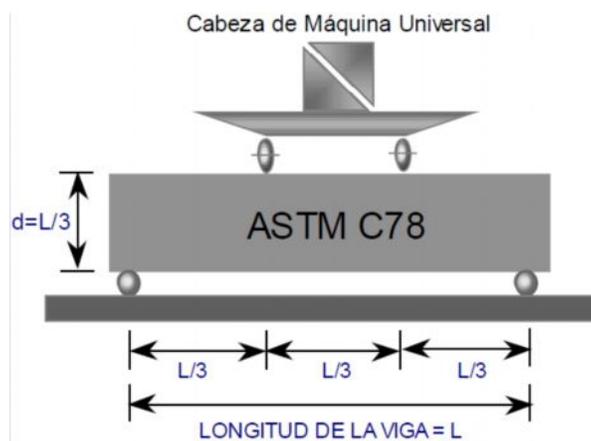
Ensayo de vigas de concreto aplicándoles carga a dos tercios de su claro de apoyo norma ASTM C78
